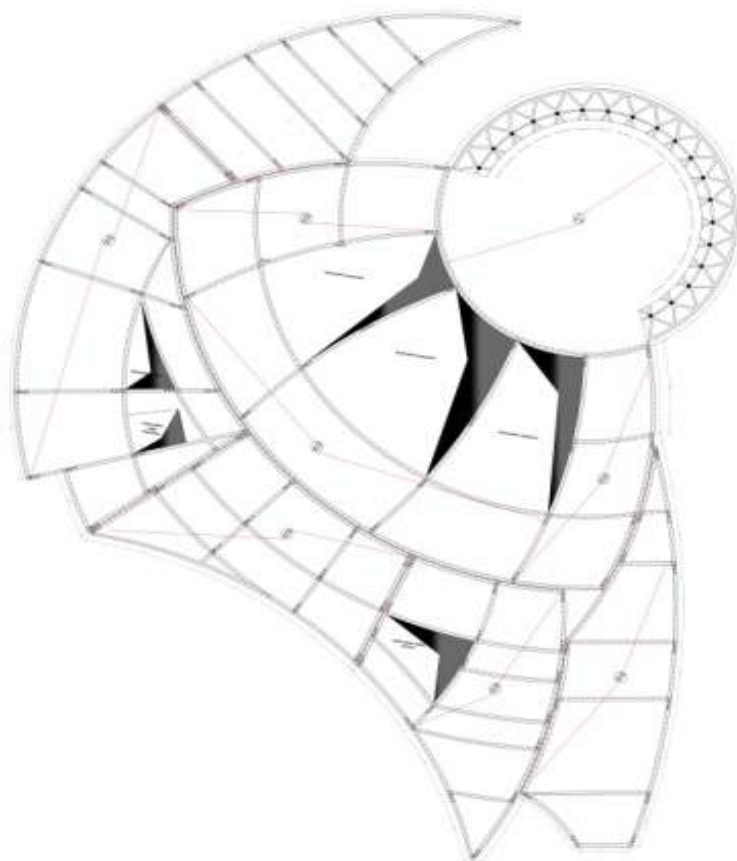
un plan de structure de premier plancher (source l'auteur)
